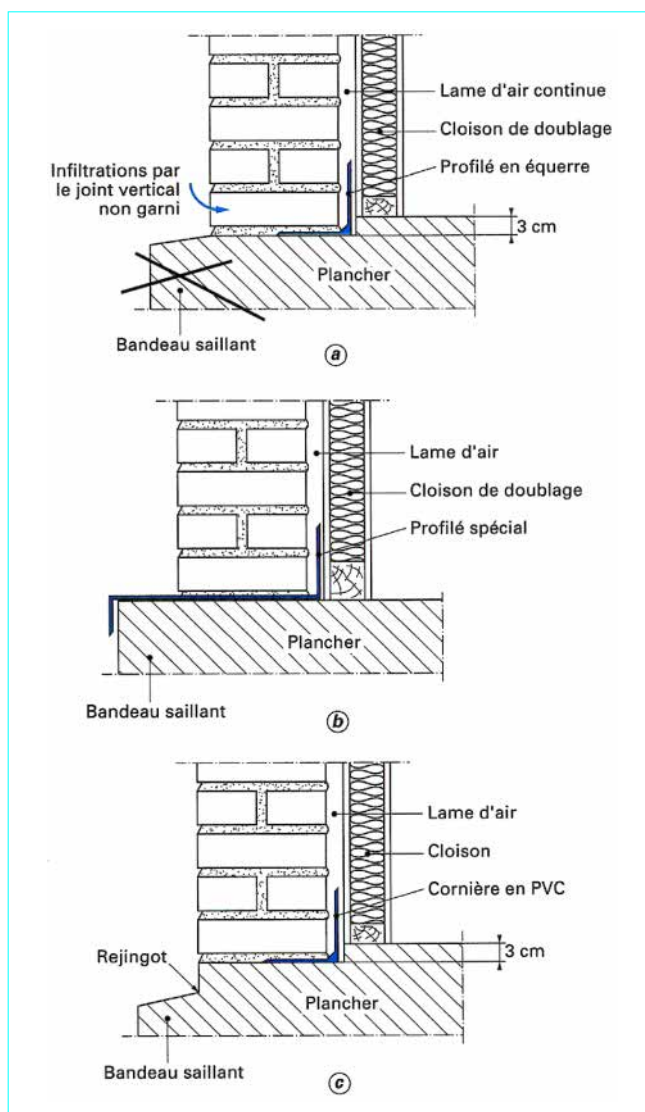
Recueil et évacuation des eaux. Murs de type III avec maçonnerie apparente. Cas des bandeaux saillants
